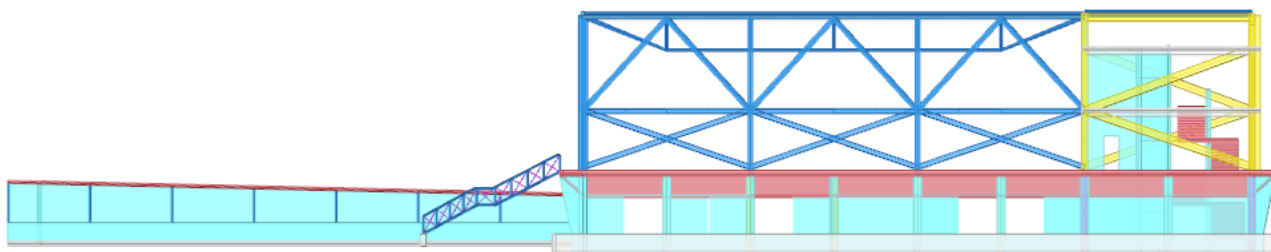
Vista 3D del Modello Strutturale FEM – Corpo A+B – Vista Prospettica Longitudinale – Stato di Progetto
